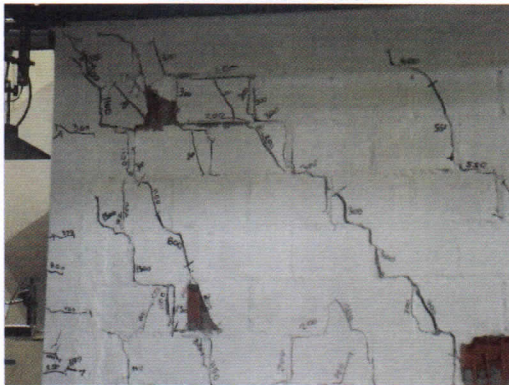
Levantamiento de ladrillo en la parte superior Oeste de la cara Sur para una distorsión de 1/150.
